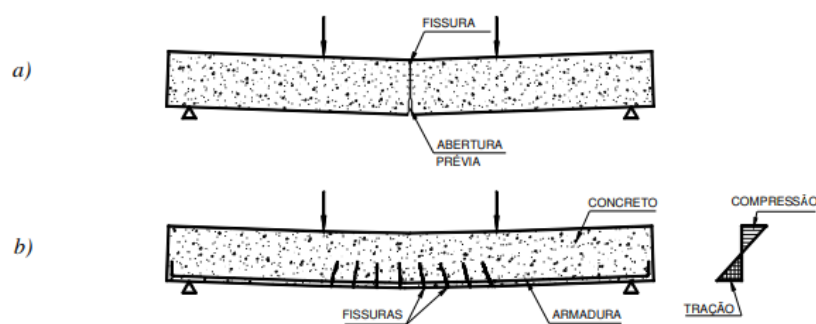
Elemento estrutural de betão a) sem armadura; b) com armadura (Pfeil, 1989)
